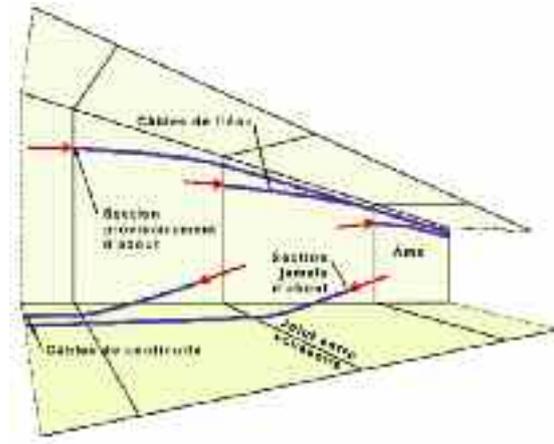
notion de sections provisoirement d'about et de sections jamais d'about
